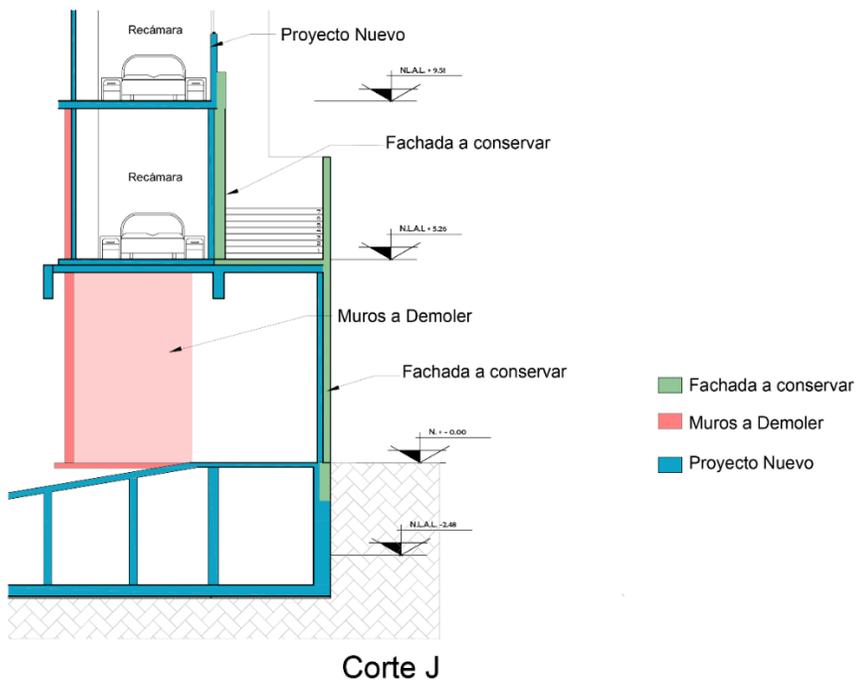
Corte por fachada de edificio Lerma 76. Elaborado por Paola Morales
